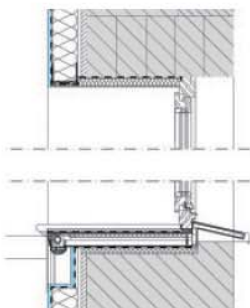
Fenster-Detail mit dezentraler Lüftungsanlage [15]
